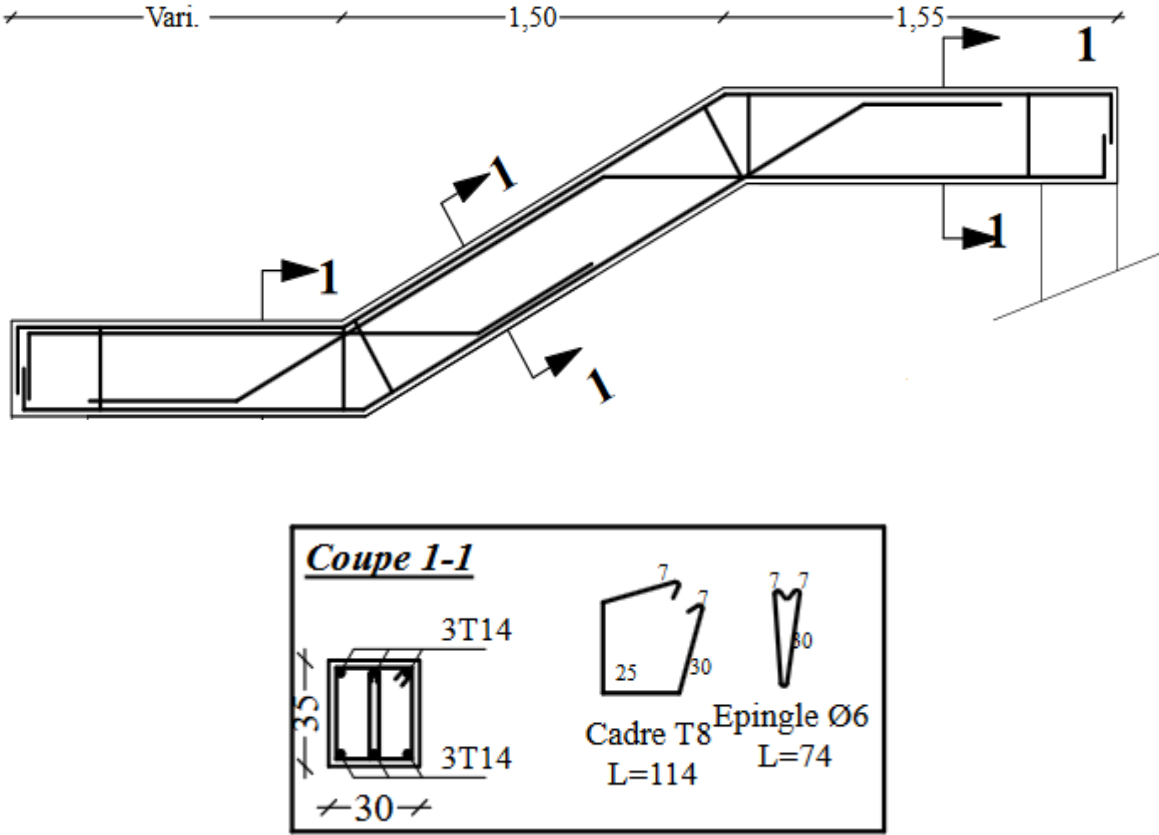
schéma de ferrailage de la poutre palière (poutre brisée)
